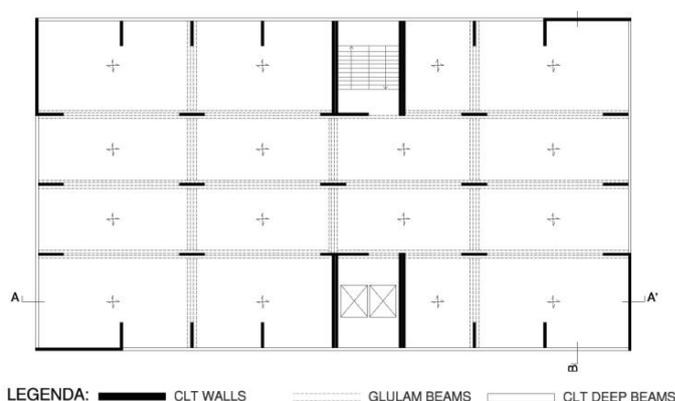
Planta do Sistema Estrutural Proposto com o *UT System*²²
